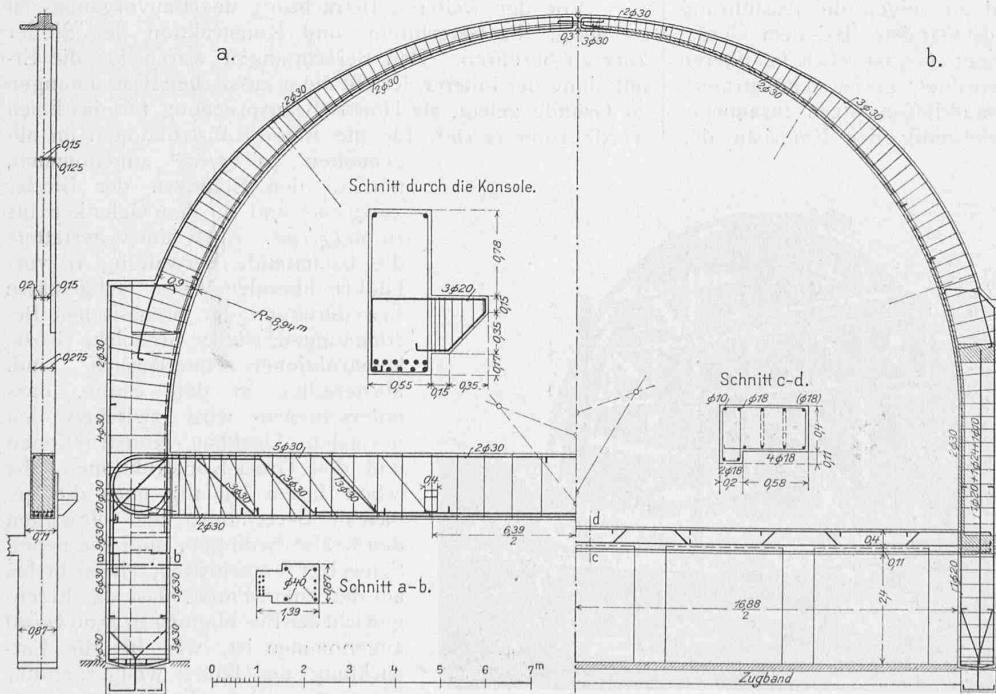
a u. b. Binder an den Kopfenden der Schalter- bzw. der Durchgangshalle. — Maßstab 1 : 150.
